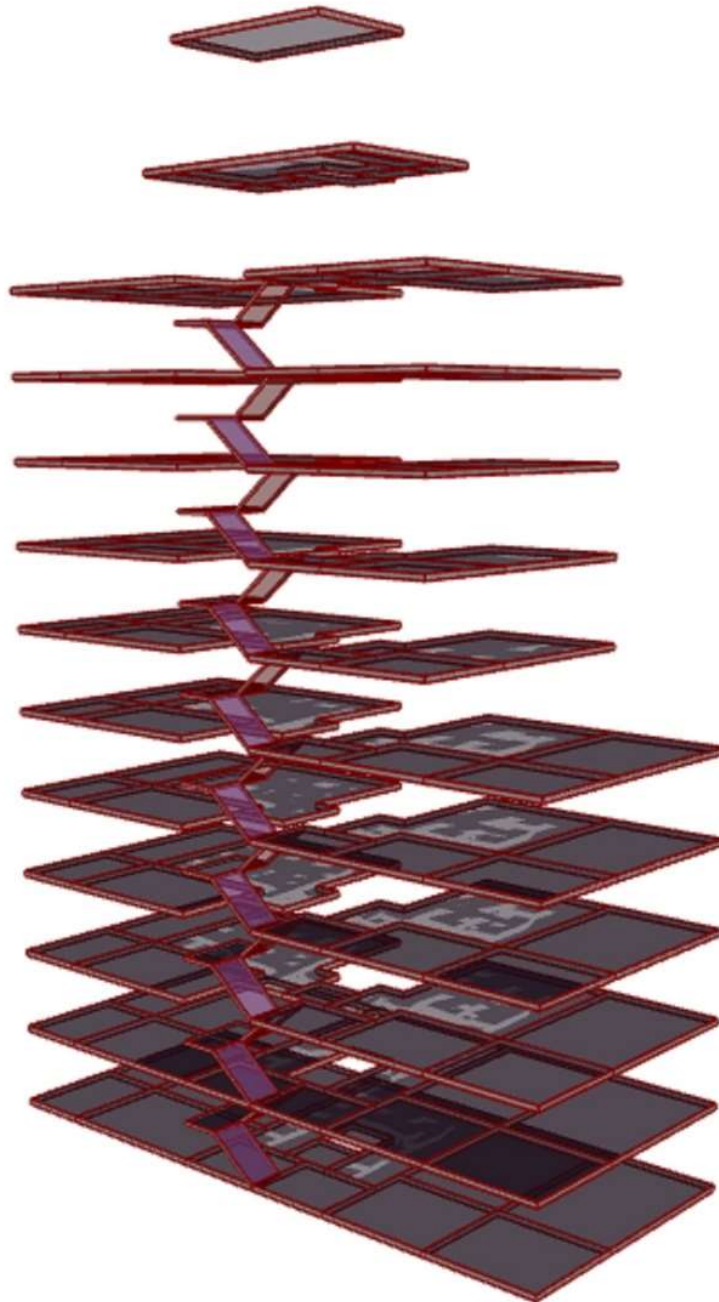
Modelado de las losas y escaleras en SAP2000
